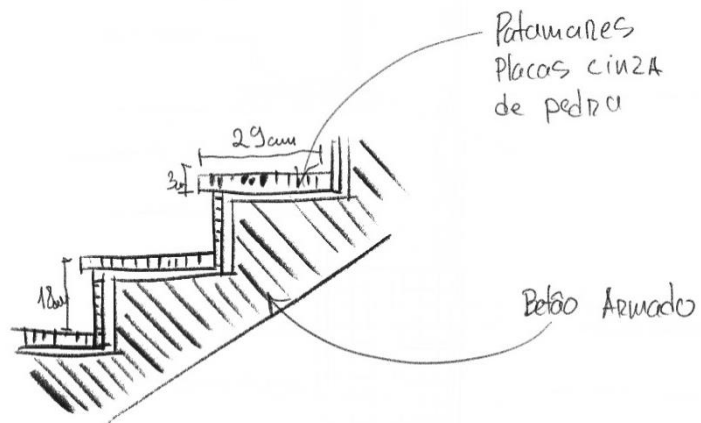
Pormenor construtivo da escadaria interior com corte com detalhe de patamares
